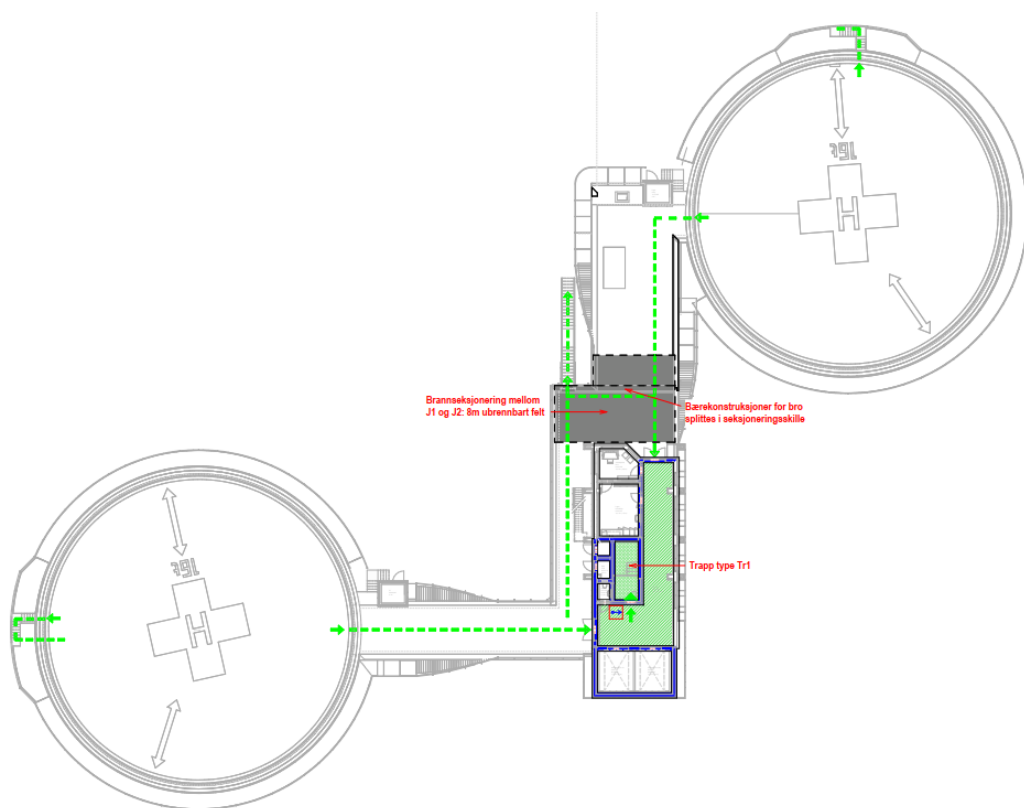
Plantegning, plan 13. Nord er oppover på tegningen.
